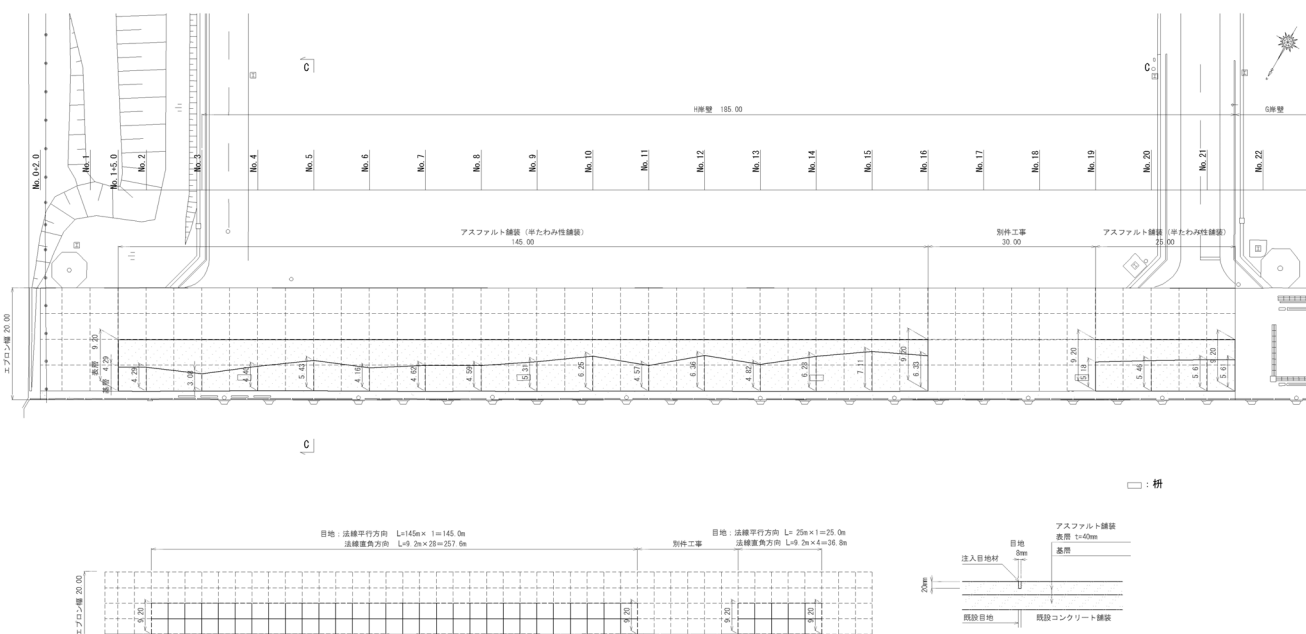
No.1 南公共ふ頭H岸壁(-10m)平面図 (復旧後)\_撤去平面
